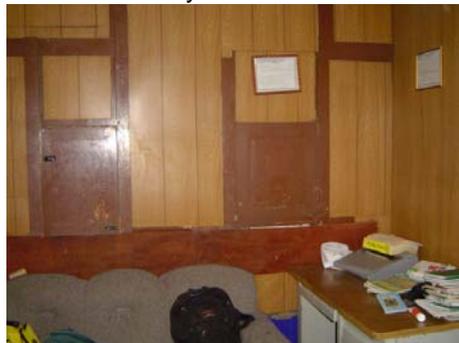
Vista oeste; Fuente: M.J.C.M.
